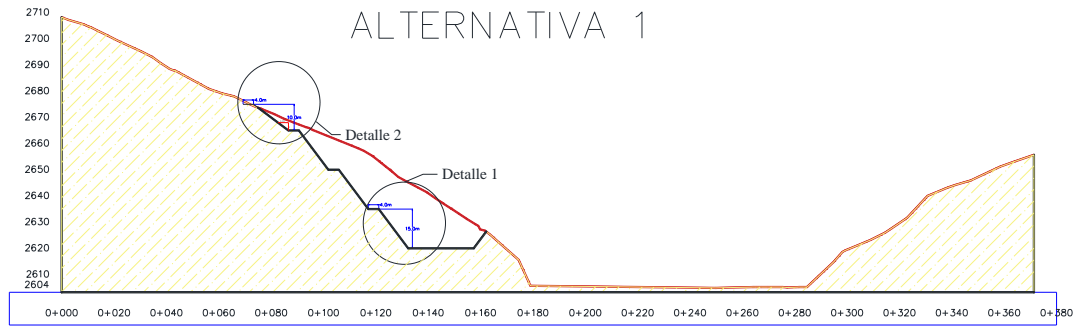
Alternativa 1, geometría de corte para trazado vial
